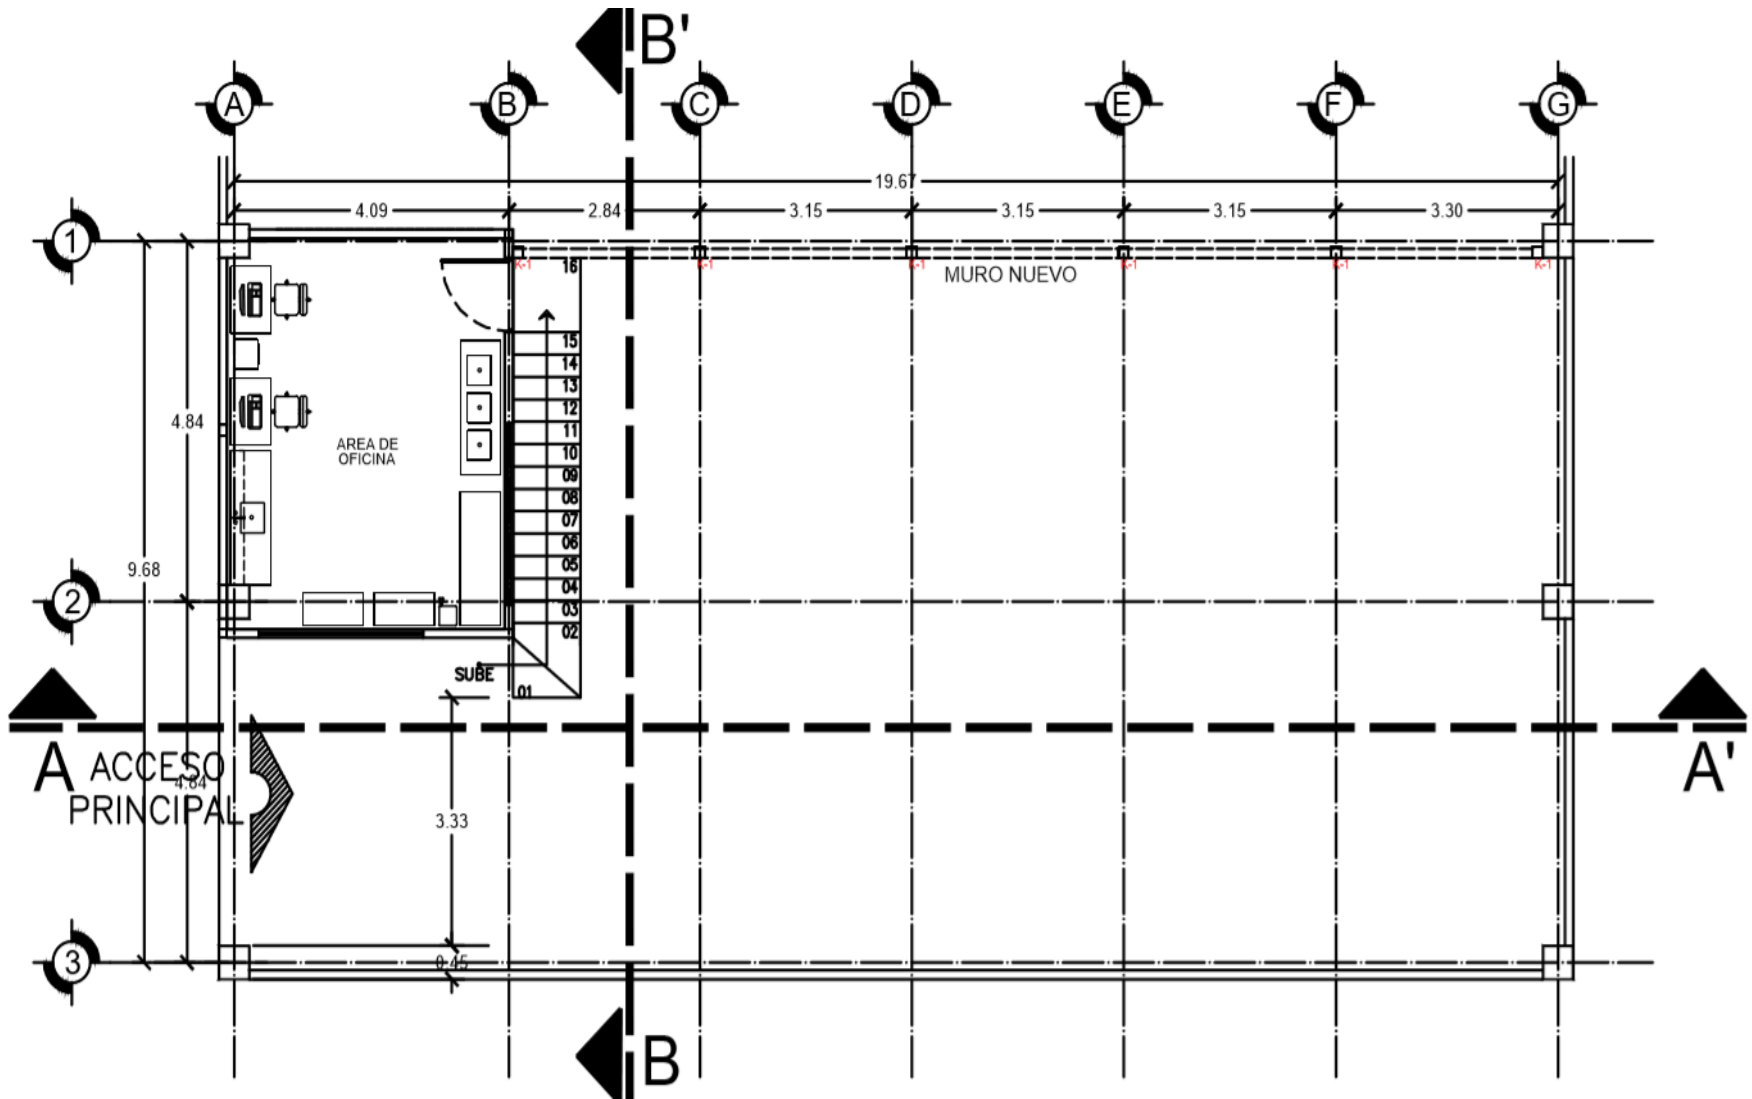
(B) Plano de la vista superior del inmueble para la instalación de la planta de biodiésel
